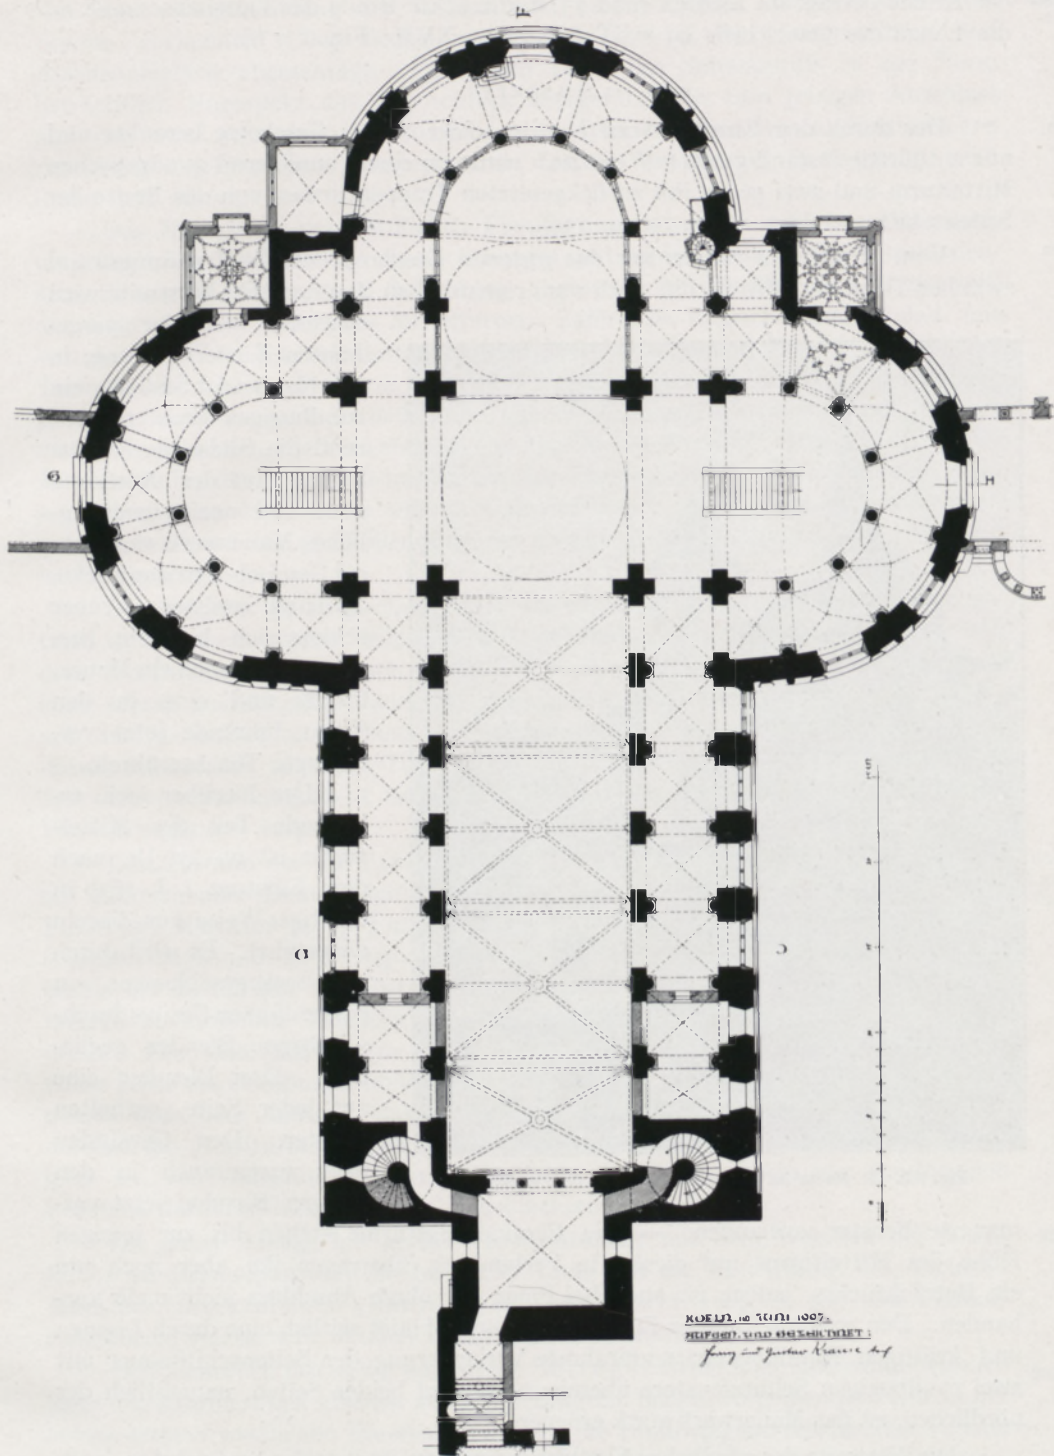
St. Maria im Kapitol. Grundriss.
